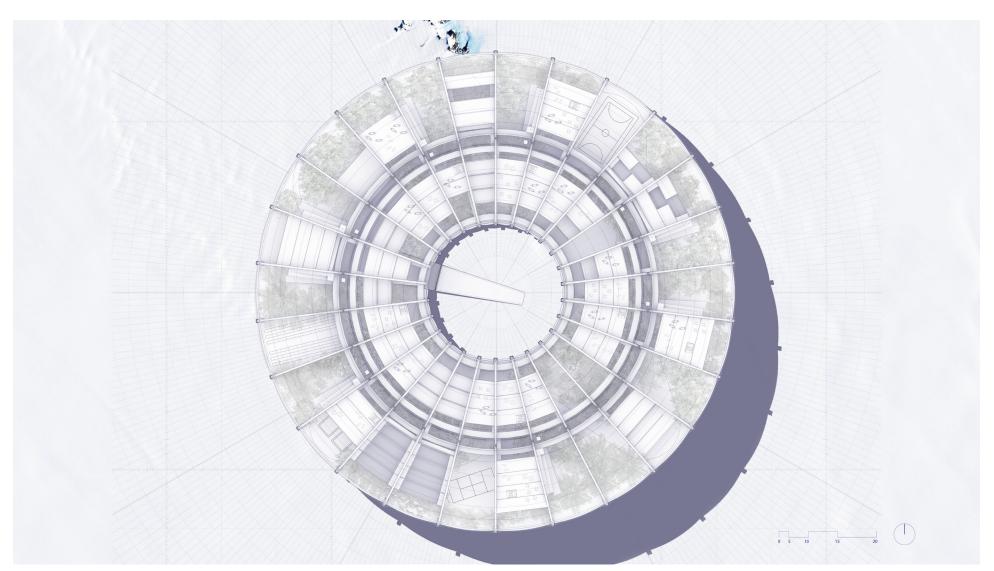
Planta de cubierta, Elaboración propia, 2021.
